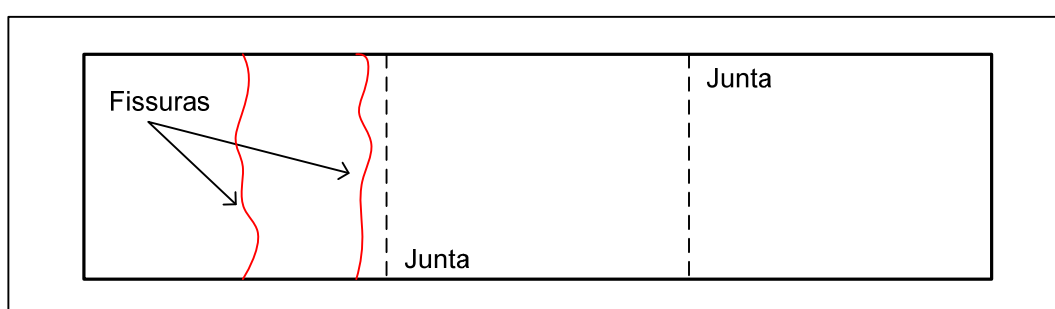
representação esquemática da configuração das fissuras, devido à retração hidráulica em pisos (adaptado de CHODOUNSKY; VIECELI, 2007)
